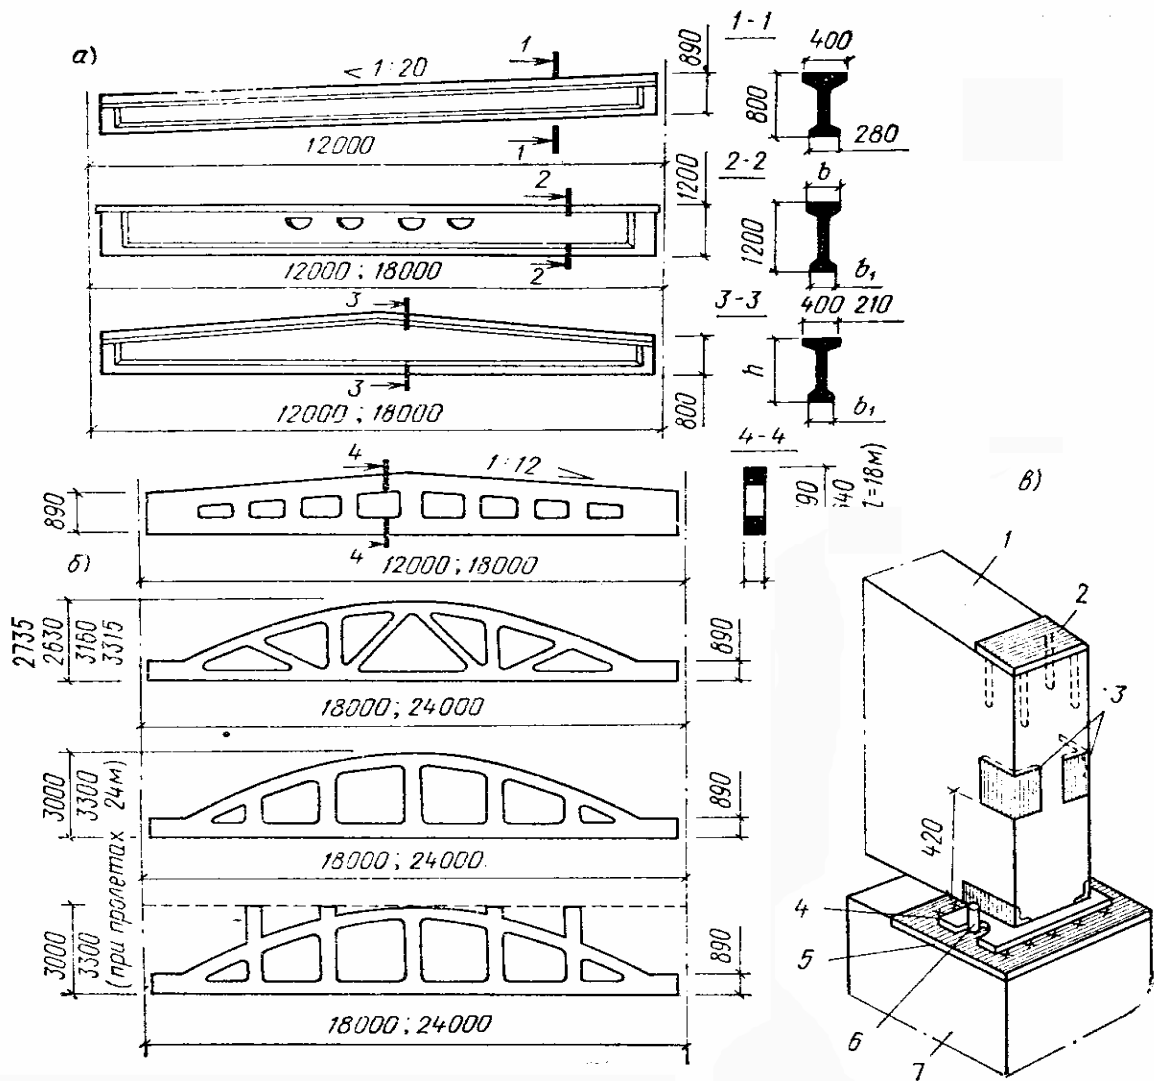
Сборные железобетонные балки и фермы покрытия:
